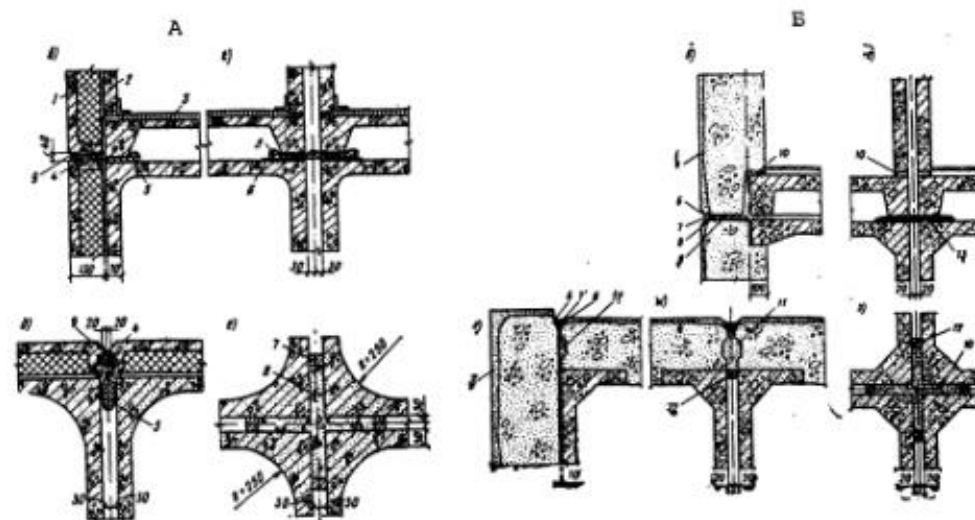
Примеры изоляции (рассечения) воздушных зазоров между объемными блоками: А - в здании типа "колпак" с приставными легобетонными наружными стенами; Б - то же, с двухслойными приставными стенами; а, б - горизонтальные стыки наружных и внутренних стен объемных блоков; в, г - вертикальные стыки; 1 - двухслойная навесная панель наружной стены; 2 - стенка "колпака"; 3 - плита пола; 4 - упругая прокладка; 5 - минеральный войлок в полиэтиленовой оболочке; 6 - руберонд; 7 - деревянная рейка; 8 - легкий бетон; 9 - герметик; 10 - цементный раствор; 11 - защитное покрытие; 12 - торцевая панель наружной стены
